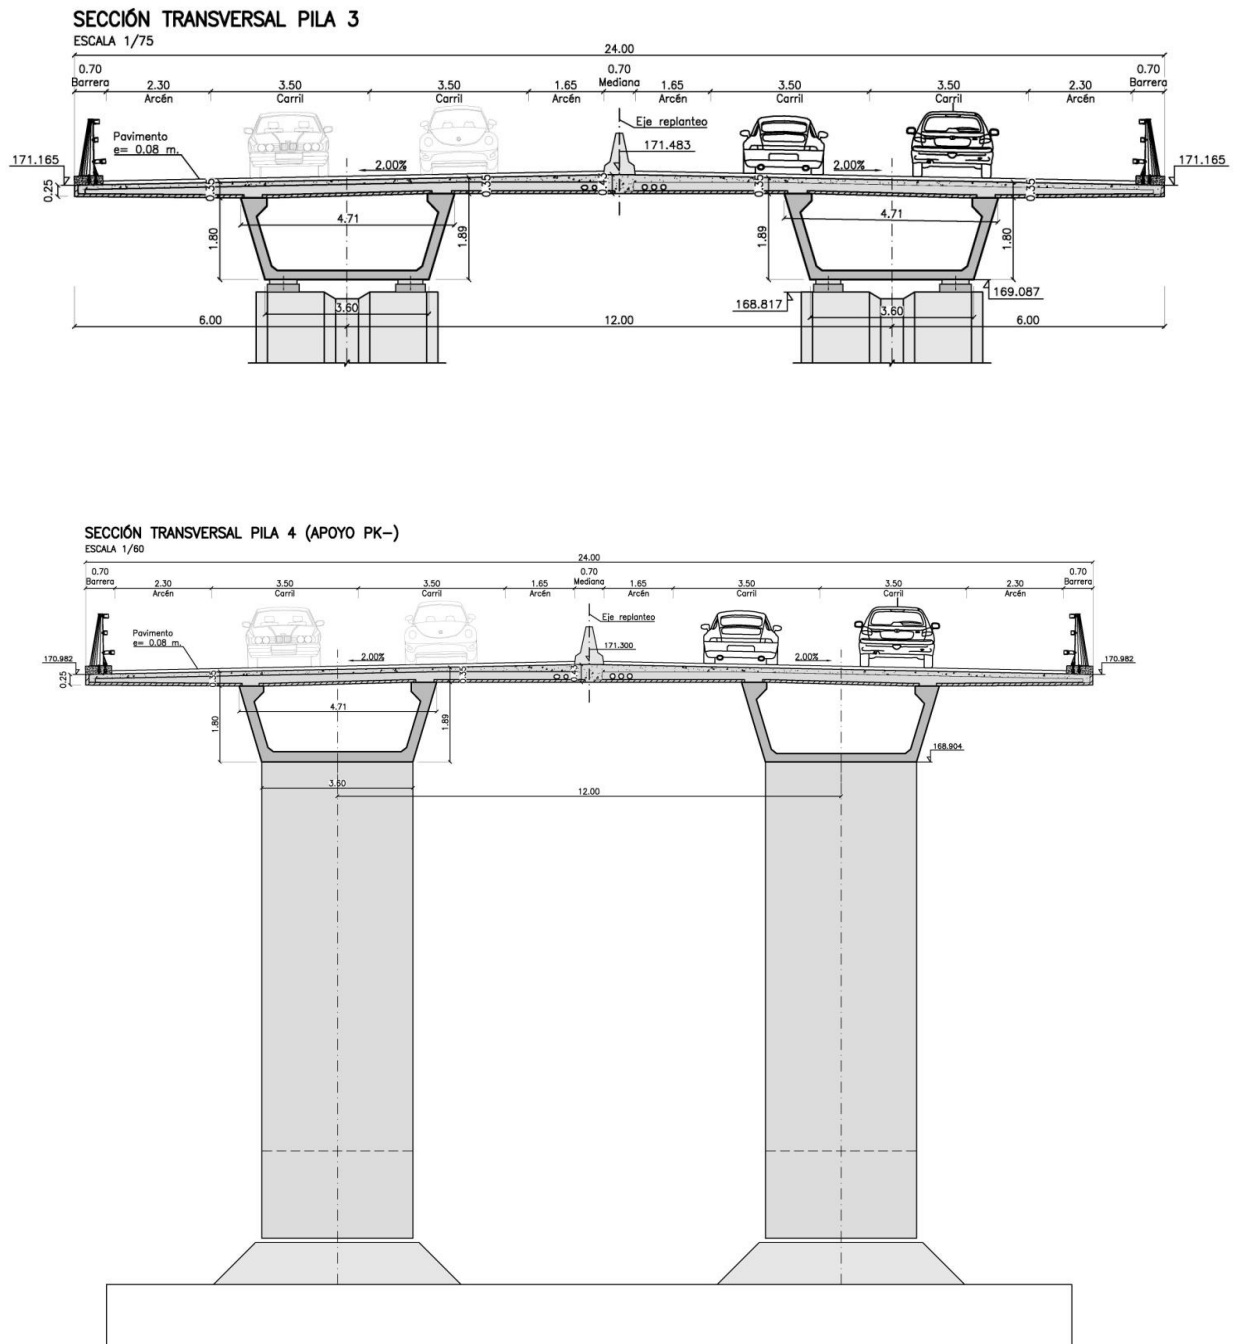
Planos de las secciones transversales del tablero en apoyos. (Fuente: Planos anteproyecto)
